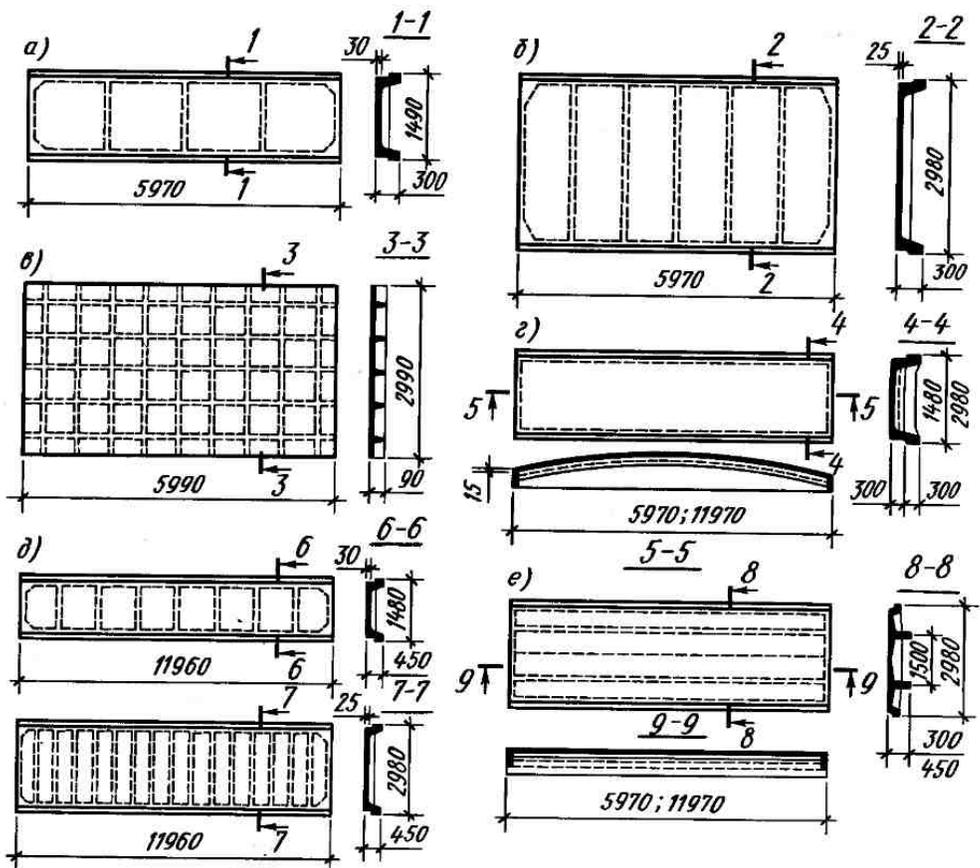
Крупноразмерные железобетонные панели покрытий:
